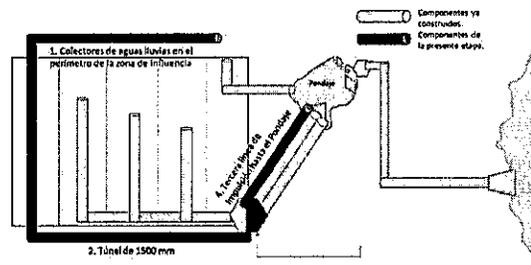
Esquema del componente alcantarillado pluvial SAI ETAPA 3.
